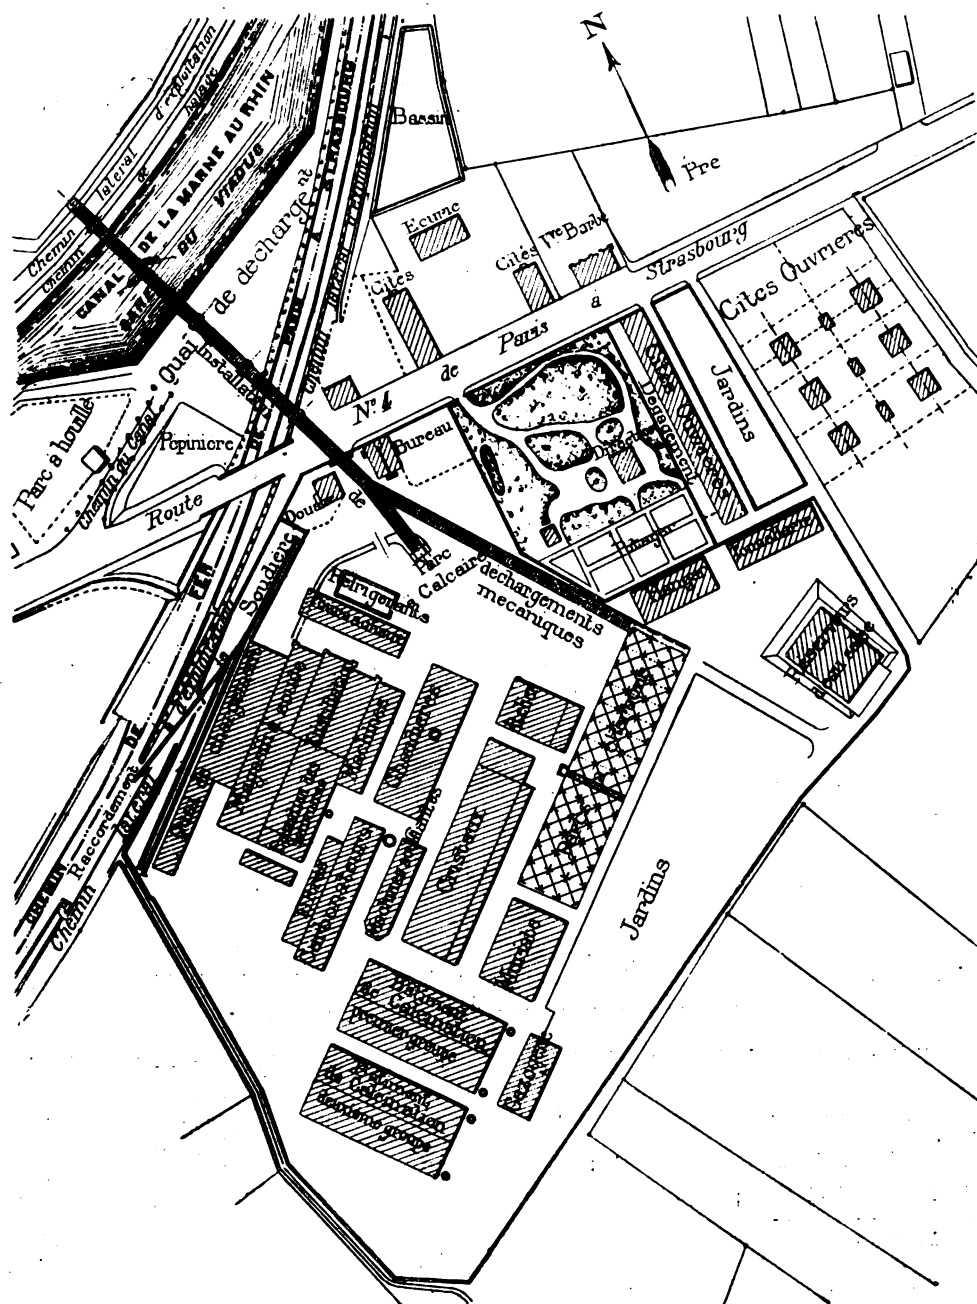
Plan d'ensemble de la Soufrière de la Madeleine.
